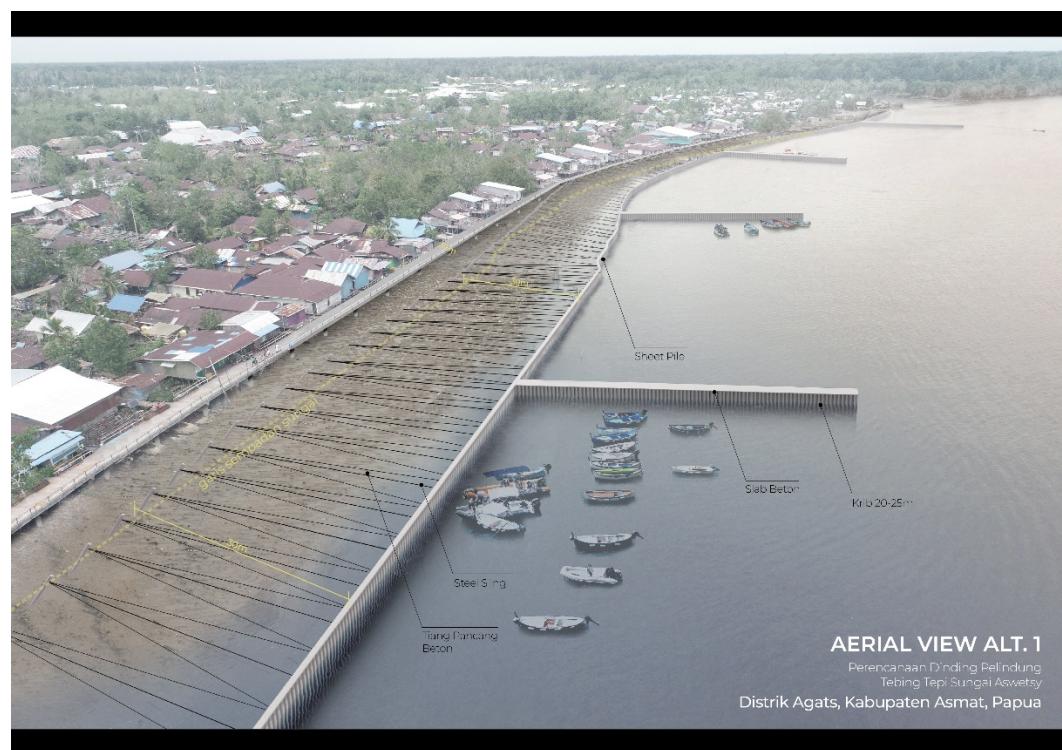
46 Parsial Rencana Pembangunan Tahap 3
